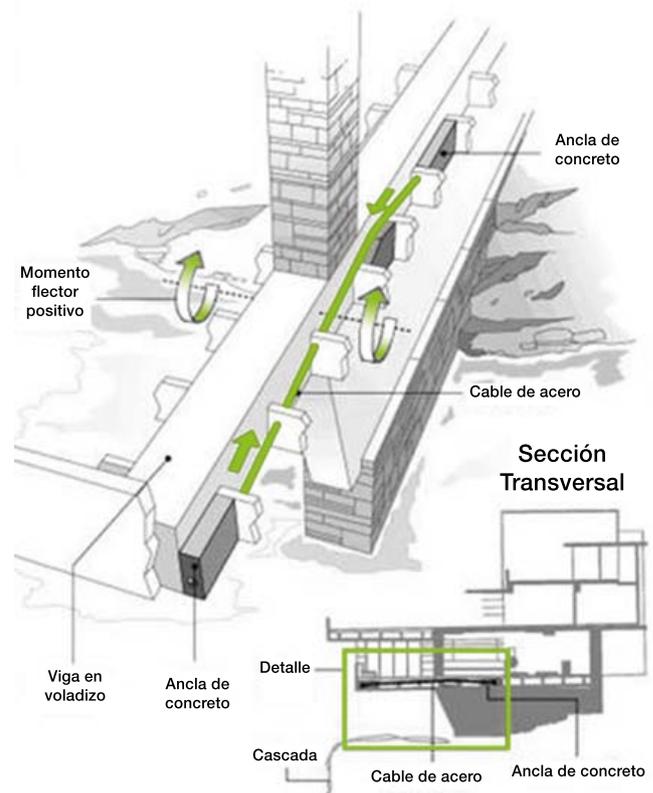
Refuerzo con cables post-tensados en vigas principales. Infografía en base a imagen.
